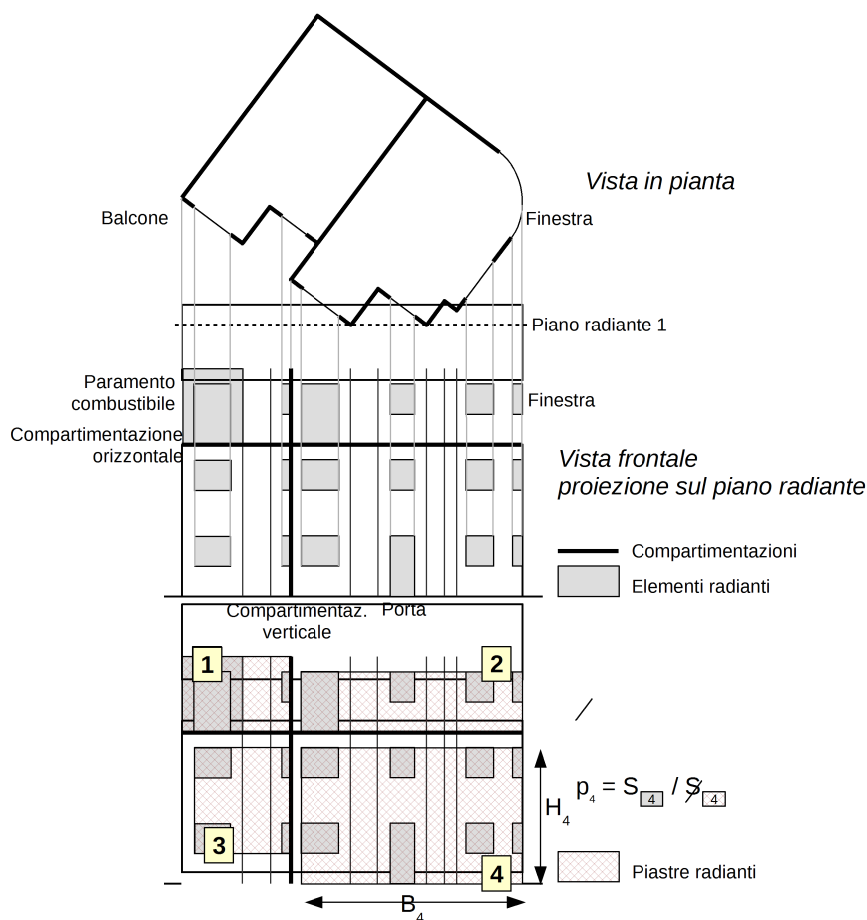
Determinazione delle piastre radianti, vista in pianta e frontale
